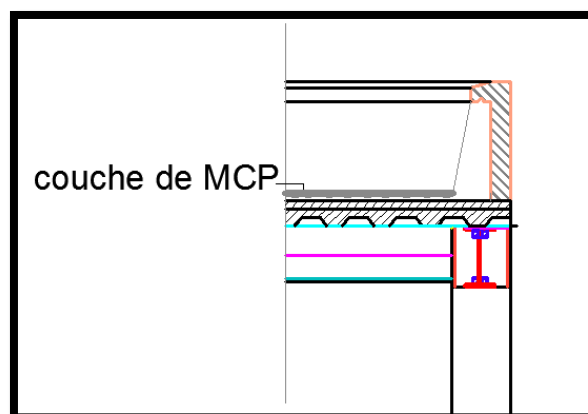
une coupe sur le planché d'une terrasse inaccessible
